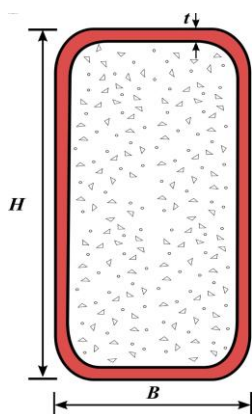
Seção transversal do perfil tubular preenchido com concreto.
